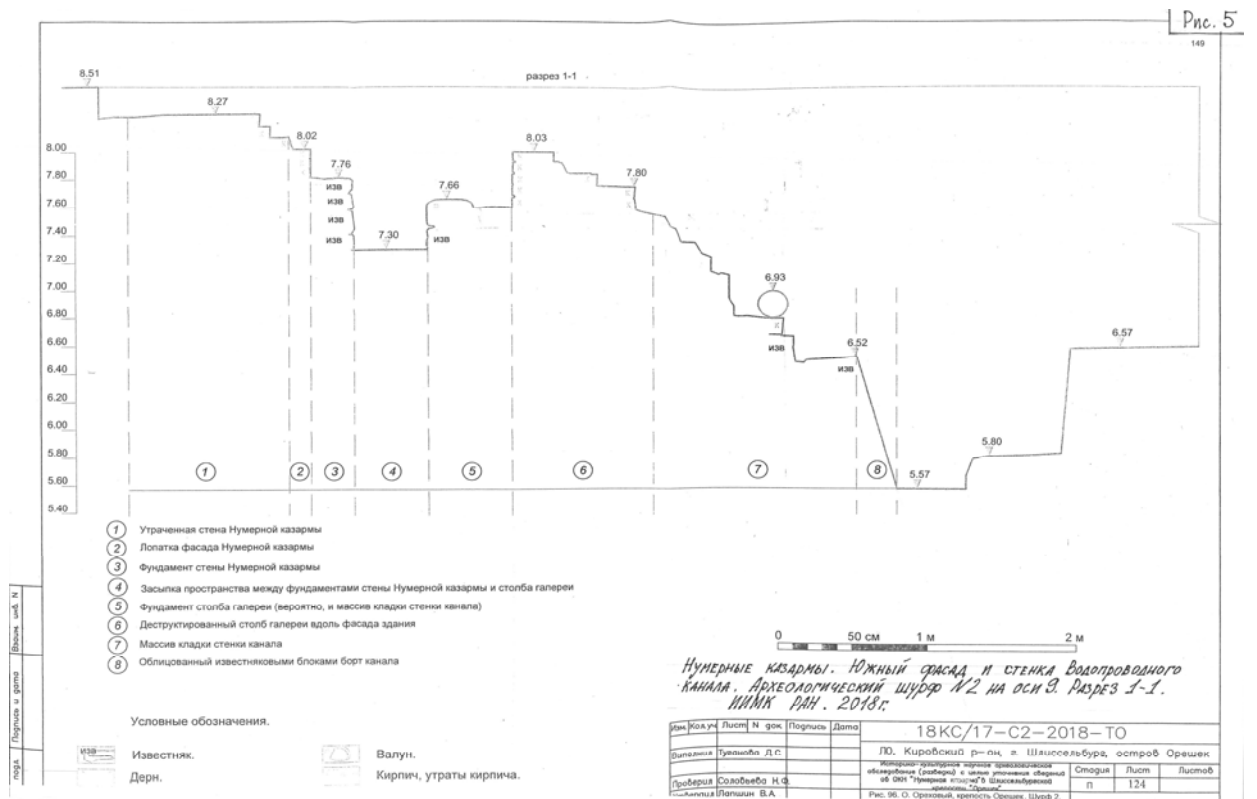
Нумерные казармы. Южный фасад и стенка Водопроводного канала. Разрез 1-1. ИИМК РАН 2018 г.
